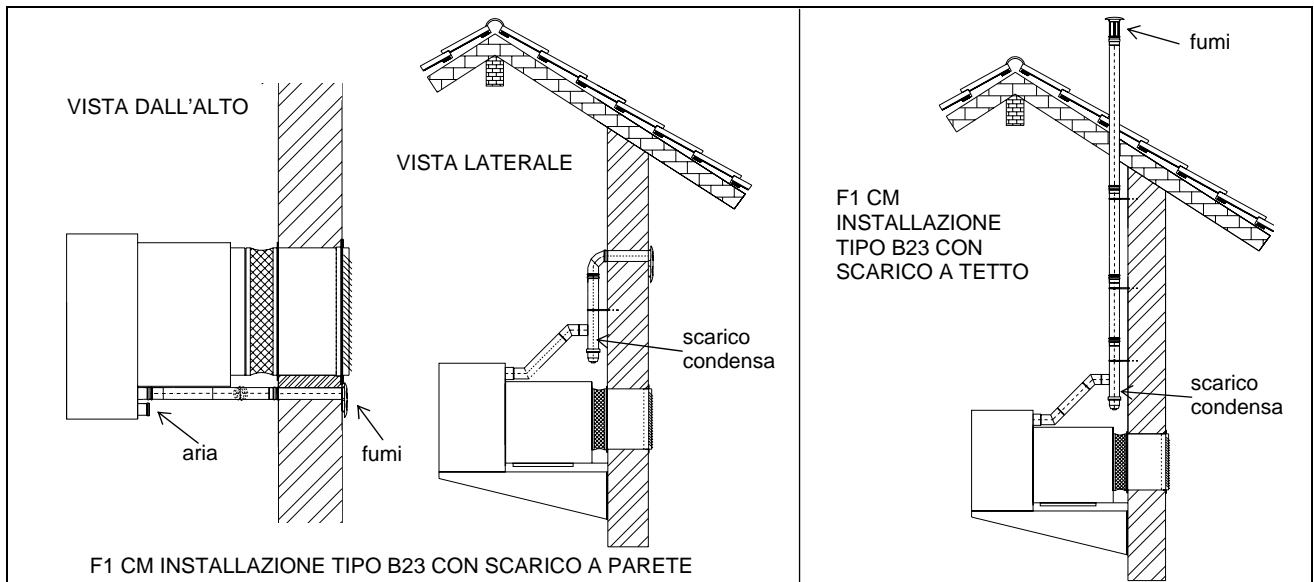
F1 CM INSTALLAZIONE TIPO B23: CON SCARICO A PARETE E CON SCARICO A TETTO
